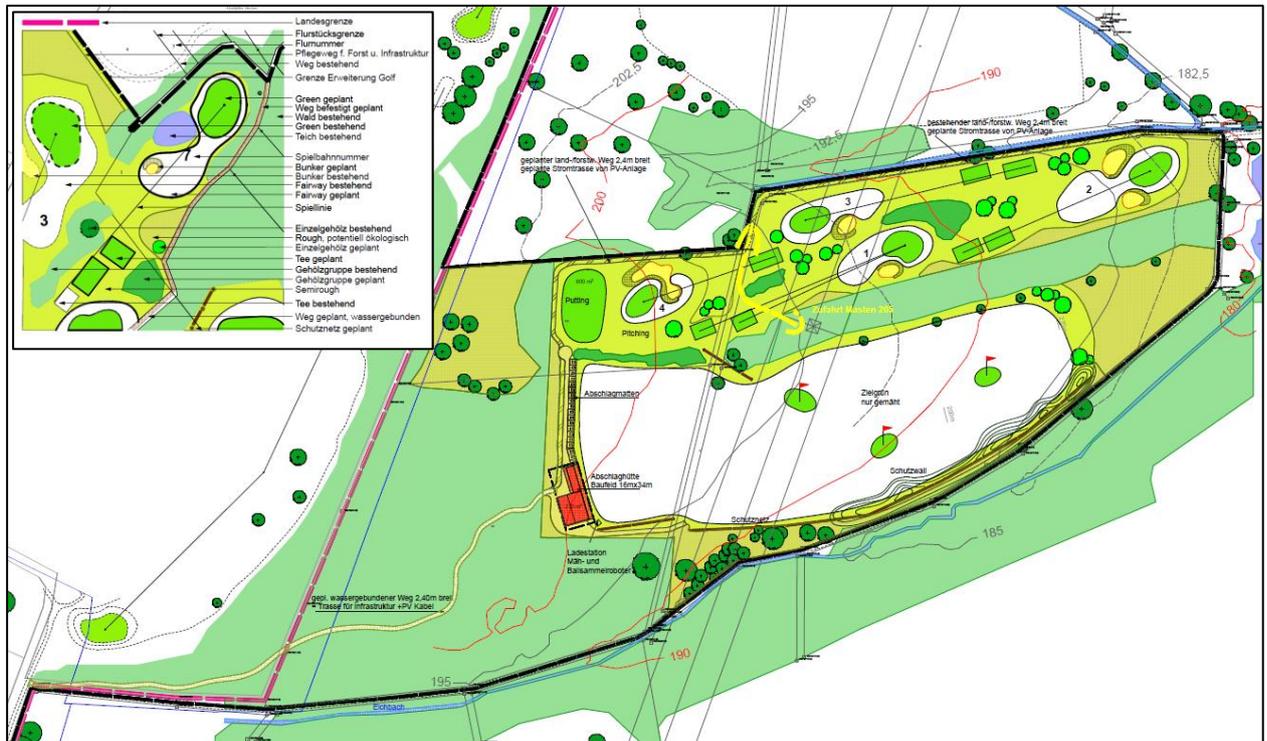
Planung Golfpark Trages (Büro Rosknecht Golfplan GmbH, Stand 18.01.2024)
